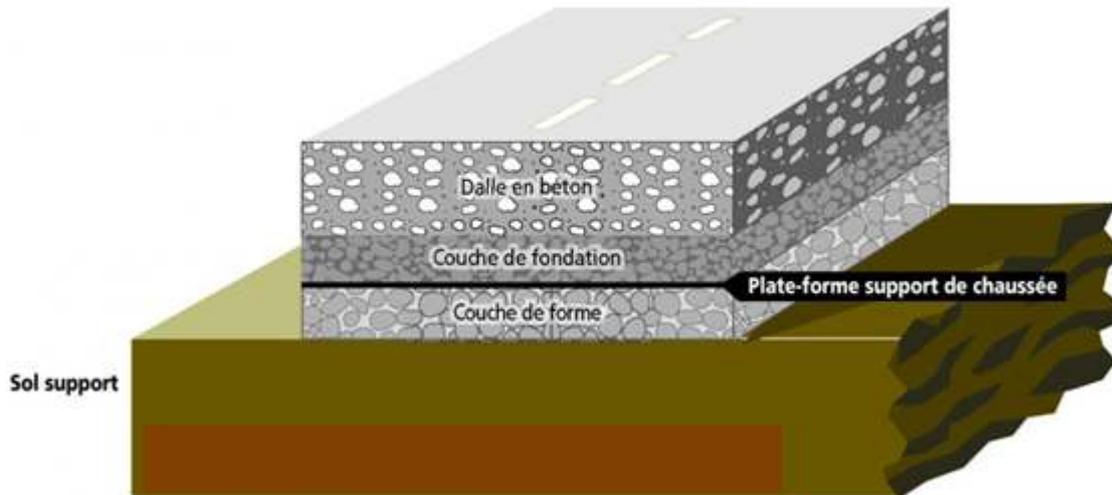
Structure type d'une chaussée rigide à trafic > 50 PL/j/sens
